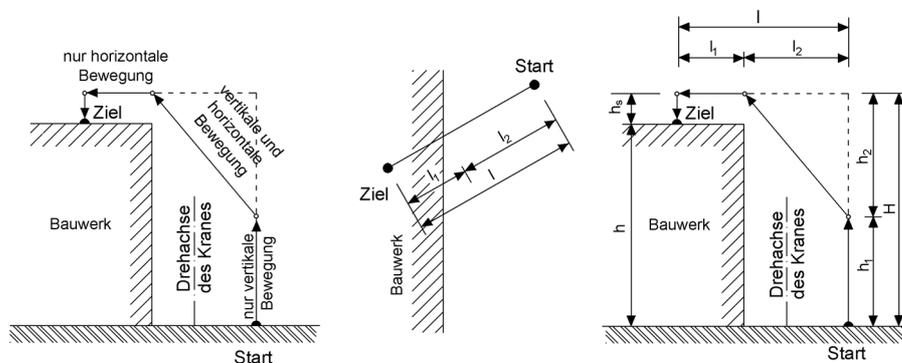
Übersicht Spielzeitberechnung nach Meyran (links: Aufriss, Mitte: Grundriss, rechts: Aufriss)
